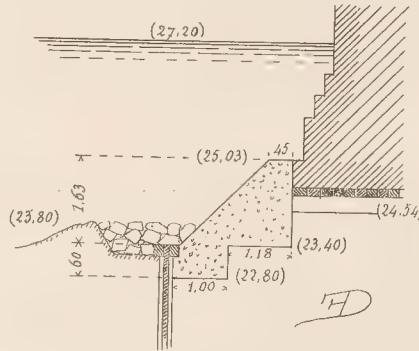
Consolidation des fondations des piles du Pont-Neuf.
